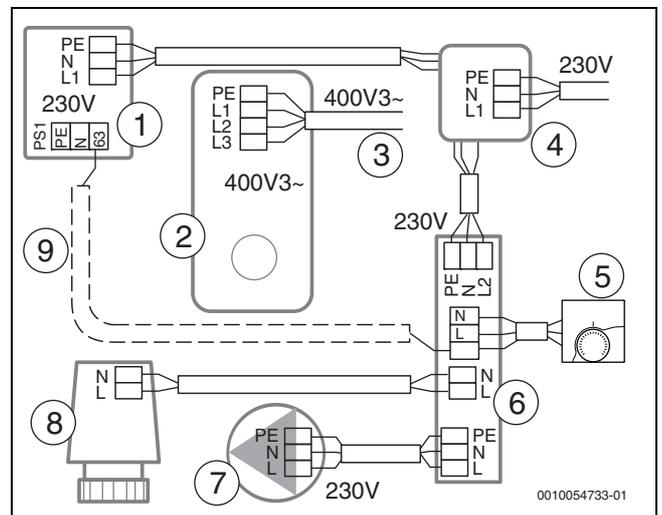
Übersicht Baugruppen und elektrische Verdrahtung
